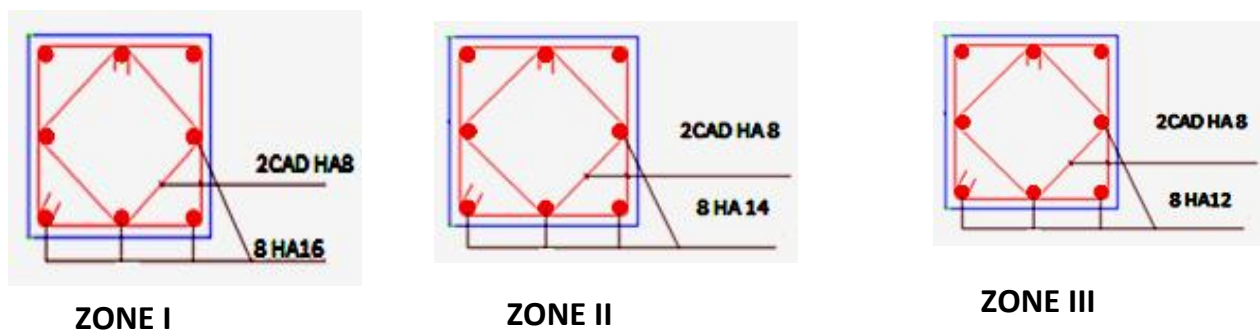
schémas de ferraillage des poteaux
